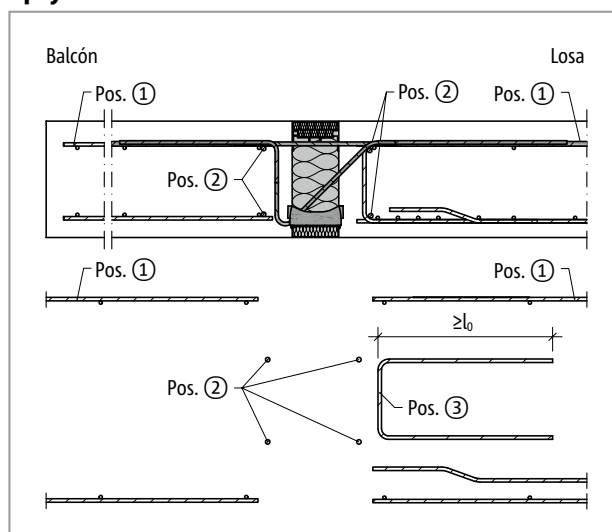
Schöck Isokorb® T tipo K-M1 hasta M11: Armadura in situ en caso de apoyo indirecto
